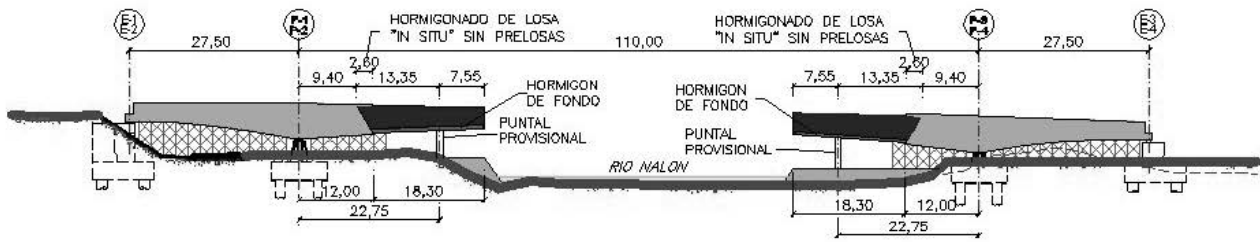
Ejecución de vanos laterales en hormigón y colocación del primer tramo metálico apeado.
